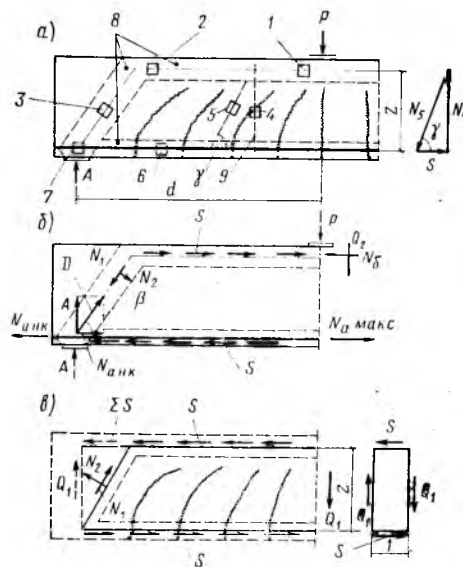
Схемы приопорного участка балки a — общий вид участка; b — усилия в сжатой и растянутой зонах, а также в опорной части балки; c — усилия, действующие на промежуточную зону балки; 1—7 — расчетные элементы балки; 8 — области силовых потоков; 9 — поперечный стержень
